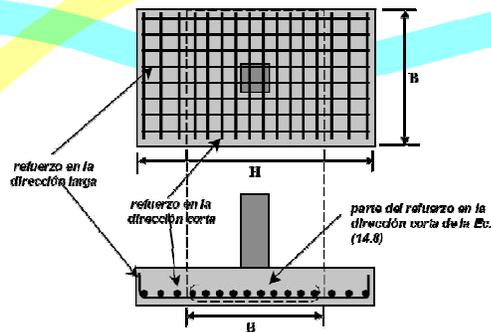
Distribución del refuerzo en zapatas rectangulares aisladas
